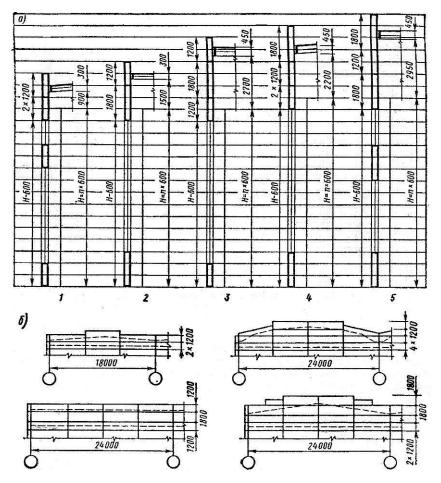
Схемы раскладки панелей в стенах одноэтажных зданий а- в продольных стенах, 1-3 —при железобетонных балках и фермах покрытия, 4,5 — при стальных фермах покрытия, б- в торцовых стенах при пролетах 18 и 24 м
